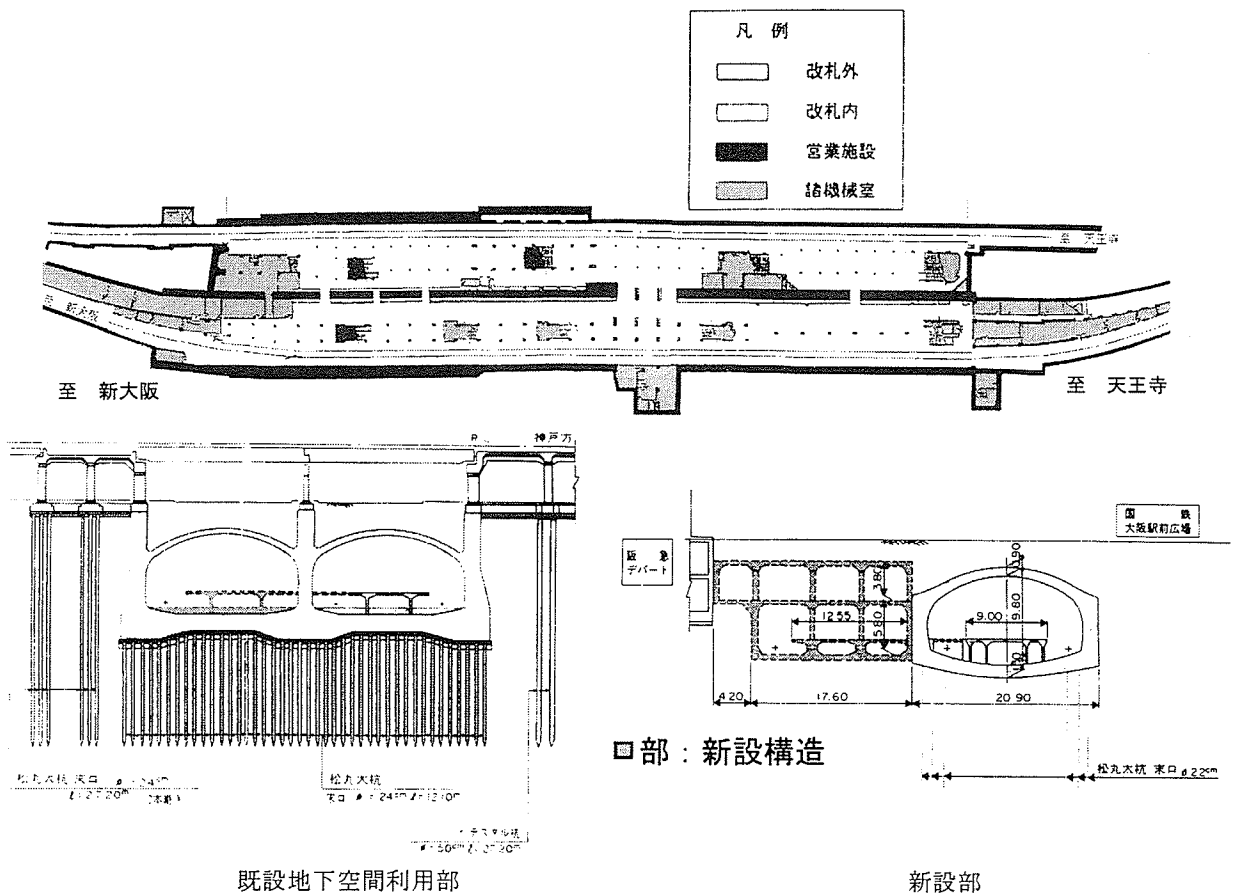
改装後梅田停留場ホーム階の平面図・断面図 (原図：大阪市)
